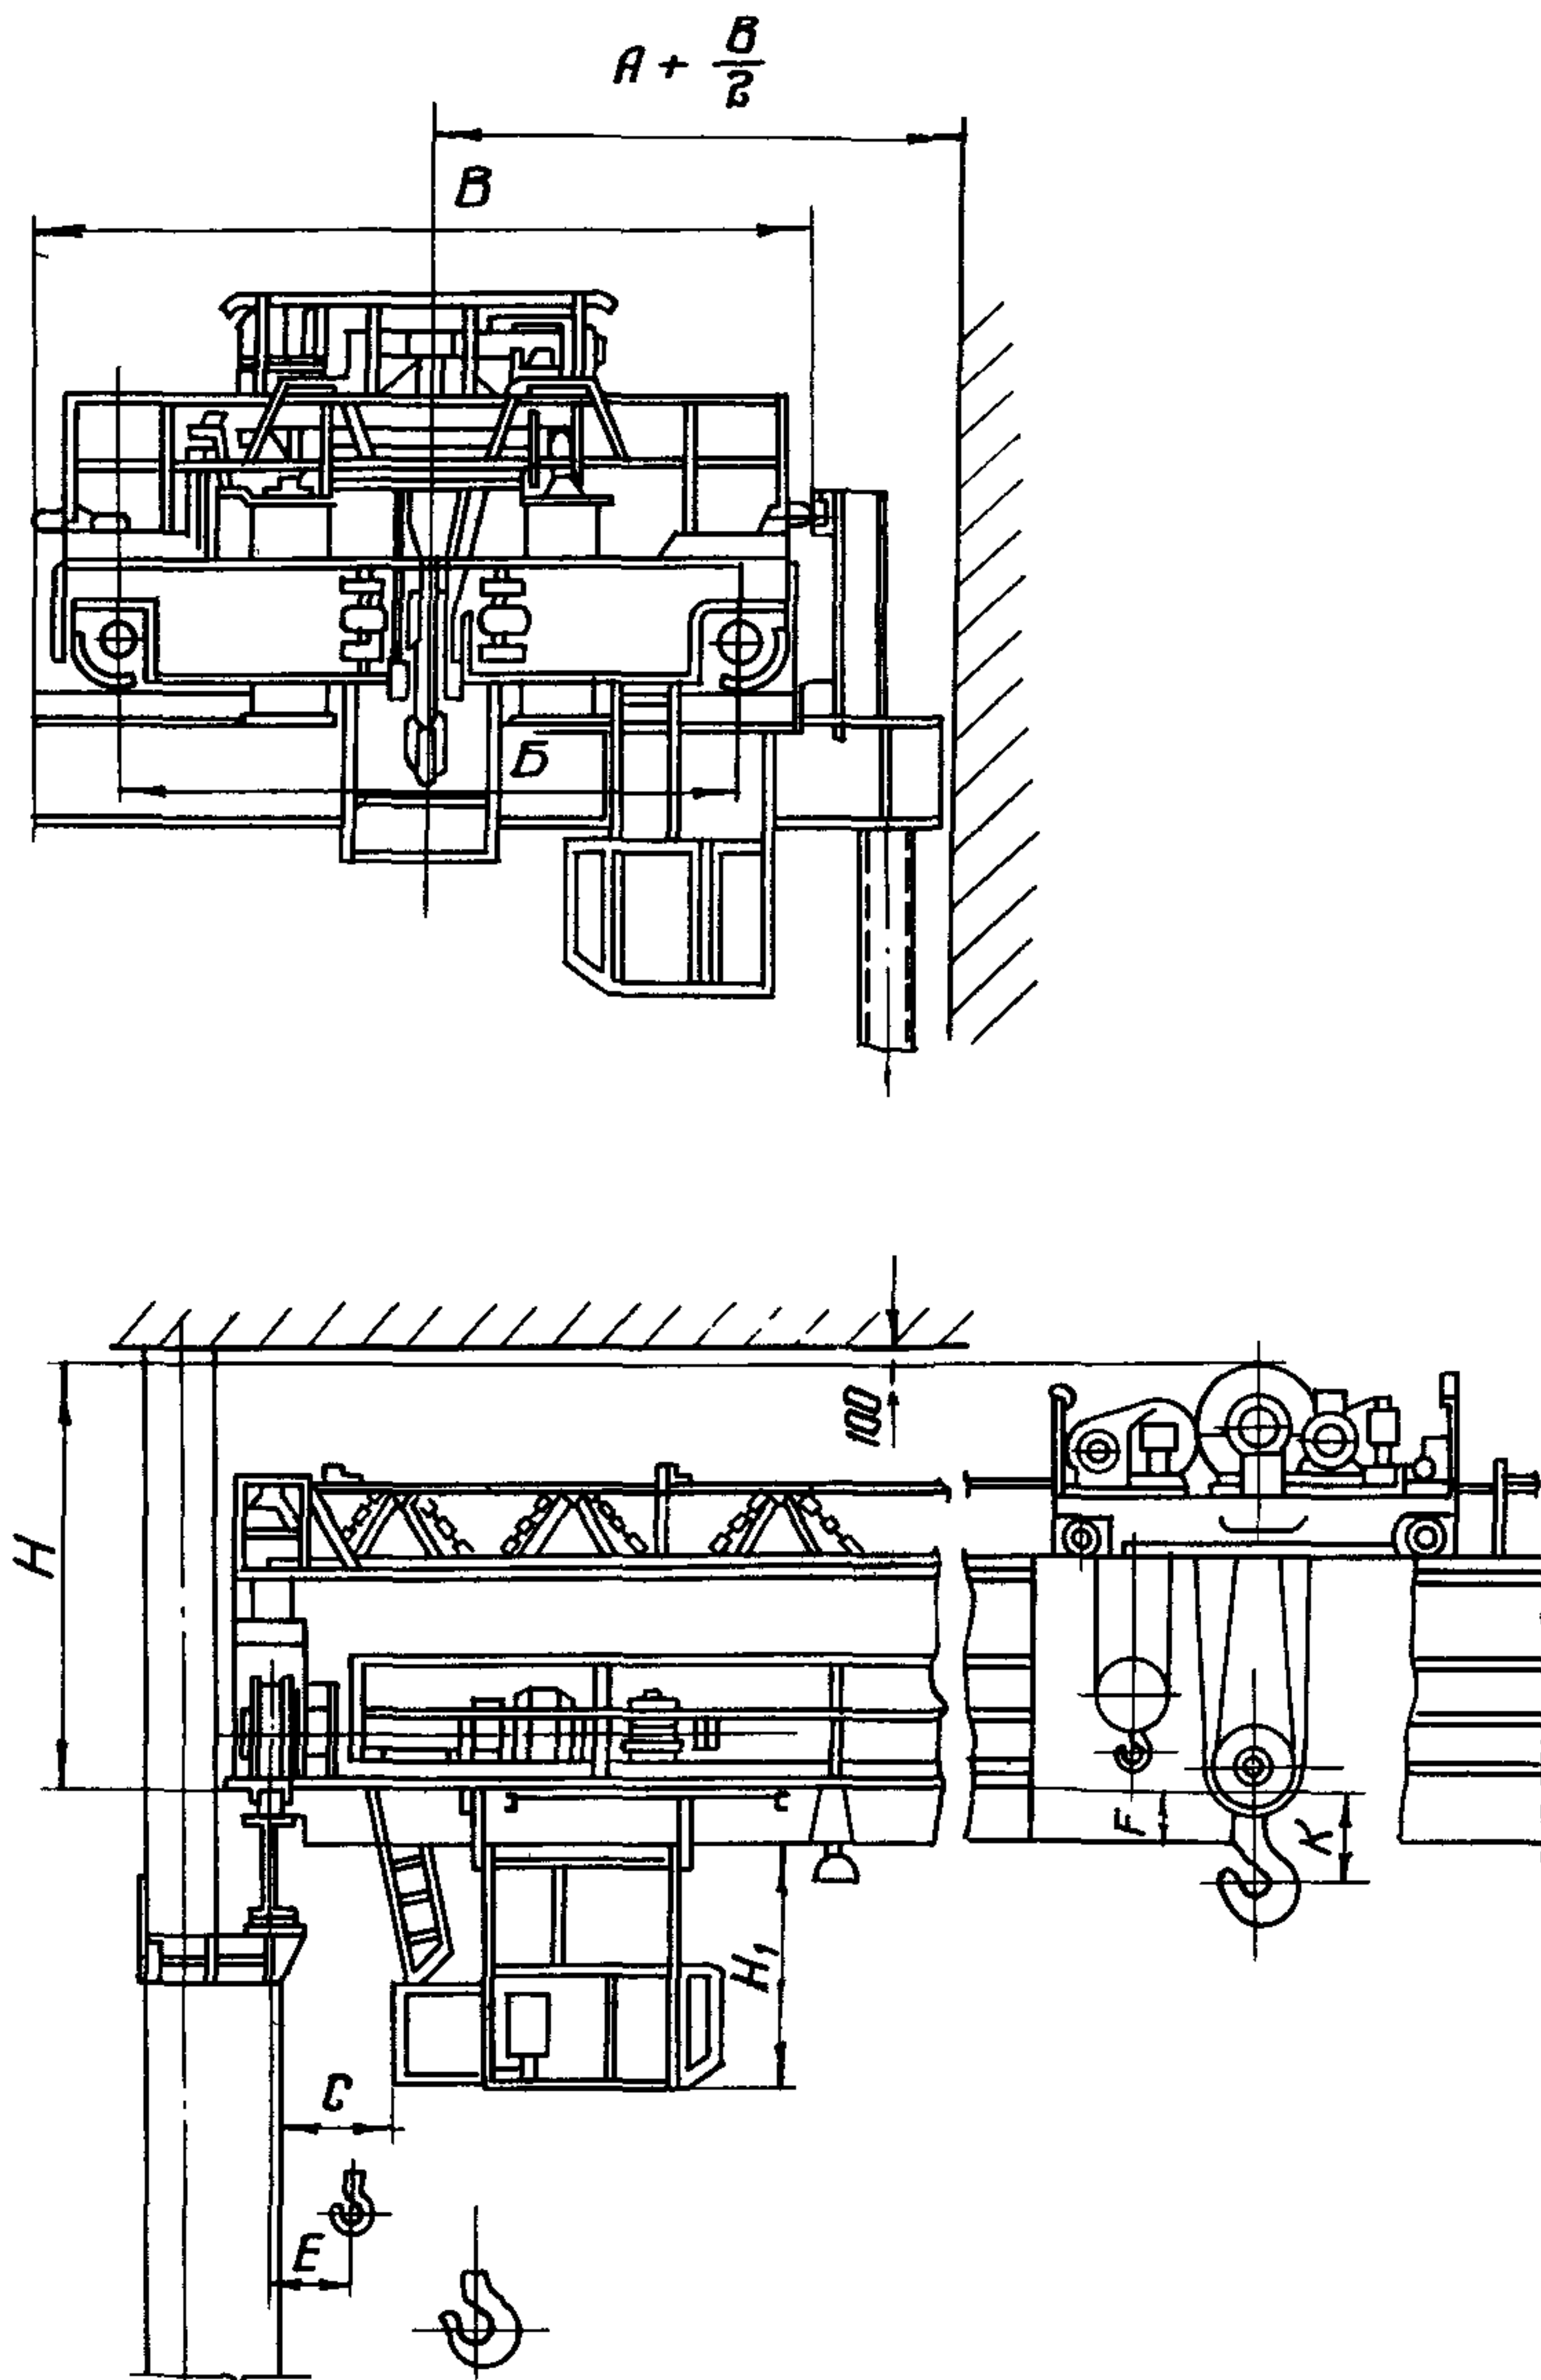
Схема приближения крюка крана к строительным конструкциям и основные параметры крана
